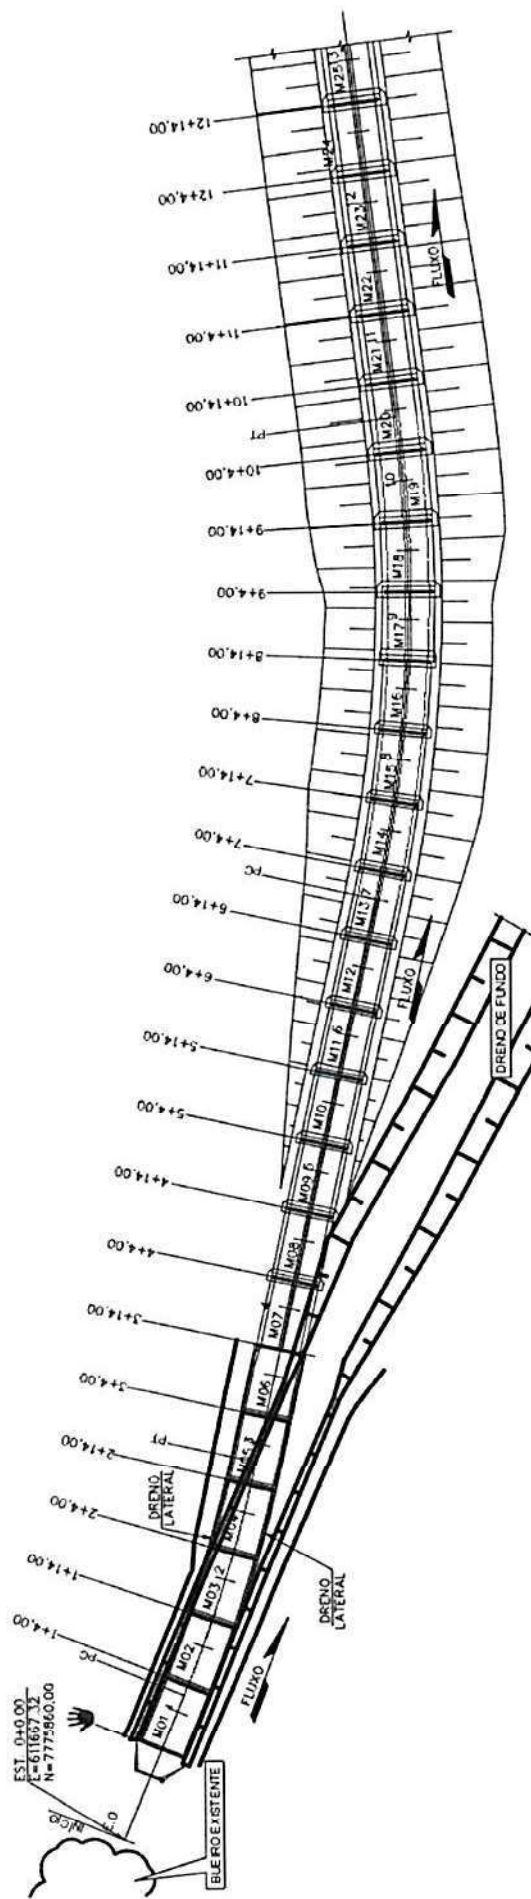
Planta das estruturas de drenagem: bueiro existente, canal complementar e galeria (Fonte: Doc. [19]).
